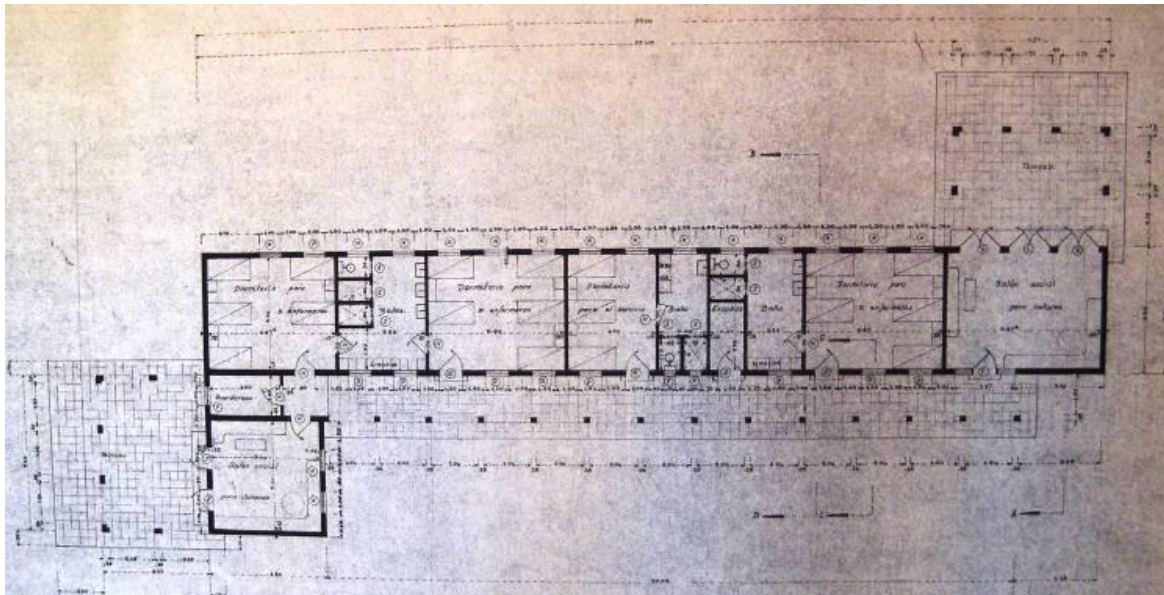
Grundriss der Unterkunft des Dienstpersonals.
